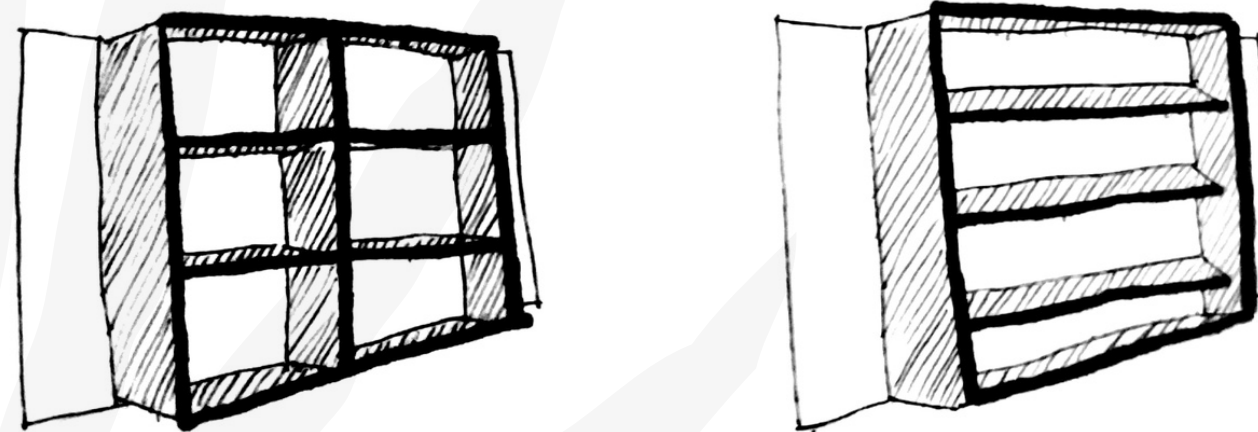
Croqui de brises-soleil mistos. Fonte: Elaboração própria da autora.
